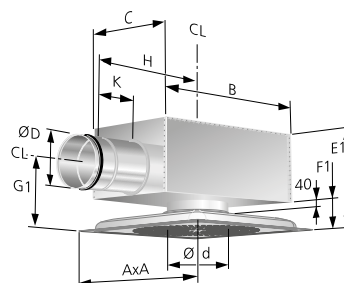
LOCKZONE Ceiling avec ALS. Hauteur d'encastrement réduite.
